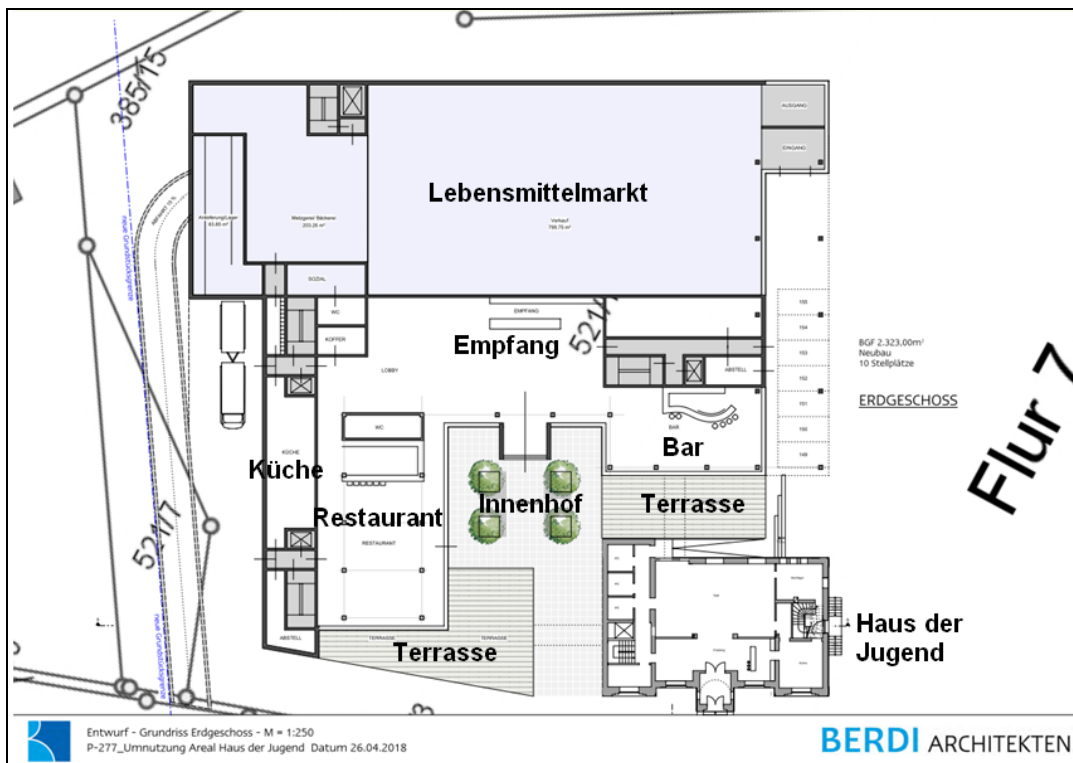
Grundriss Erdgeschoss (Hotelbereich mit Empfang/Restaurant/Bar, Lebensmittelmarkt) (Projektstand April 2018)
